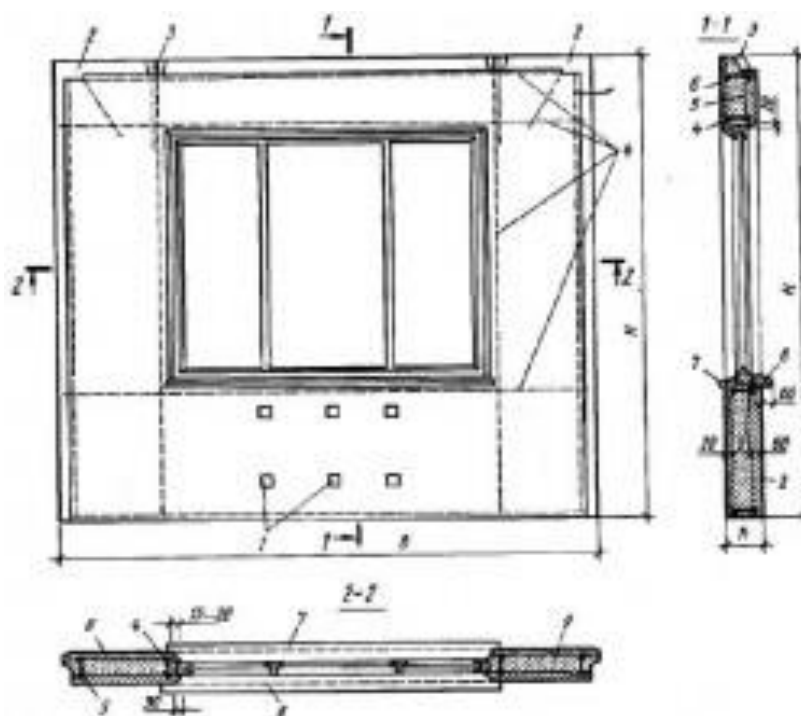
Двухслойная стеновая панель из легкого бетона;
